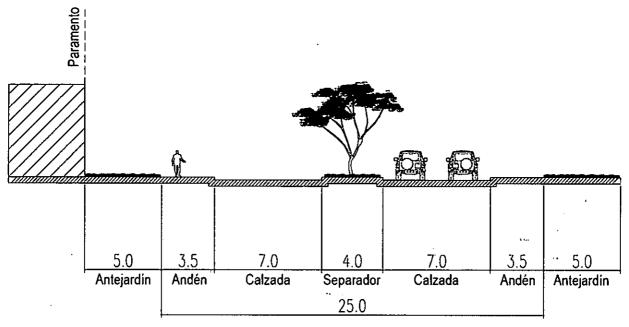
Sección vial Carrera 87 entre Calle 31 y Calle 31BB. Fuente: Equipo técnico Plan Maestro API_39 Universidad de Medellín.
